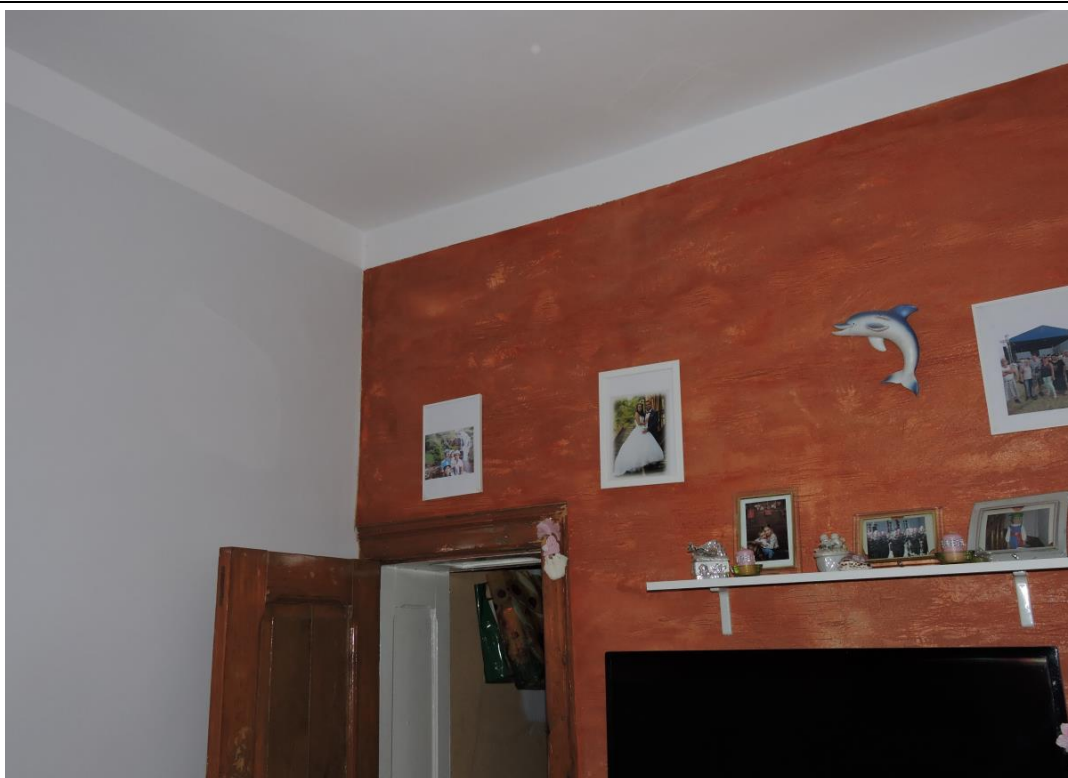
Widok na nadproże drzwiowe w części użytkowanej. Brak spękań. Stan stolarki drzwiowej bardzo dobry.
